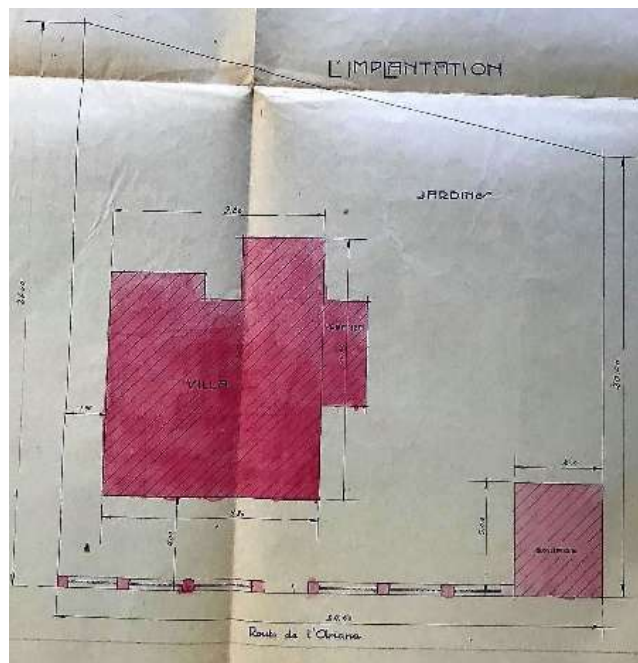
Plan d'implantation de la villa Corcos (1926)
